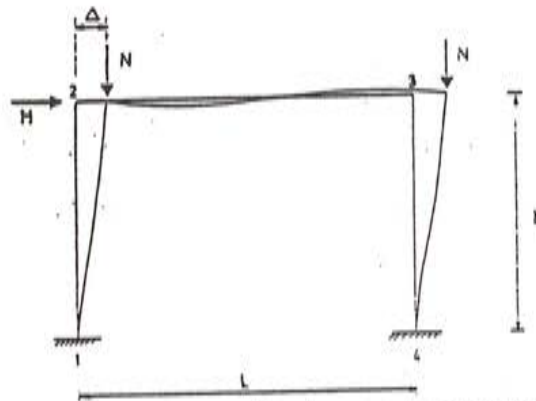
Estructura deformada bajo la acción de cargas horizontales y verticales
